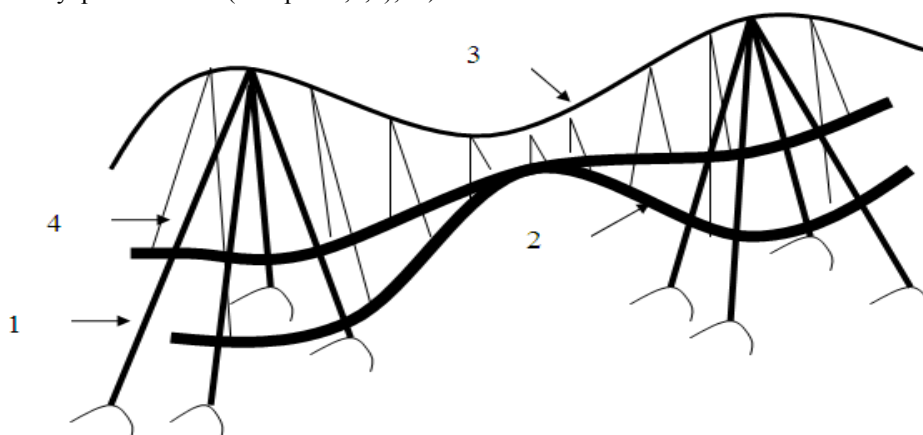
Общий вид мостотоннеля. 1 - стойки пилона; 2 – труба – балка жесткости; 3 – кабель; 4 – подвески.
